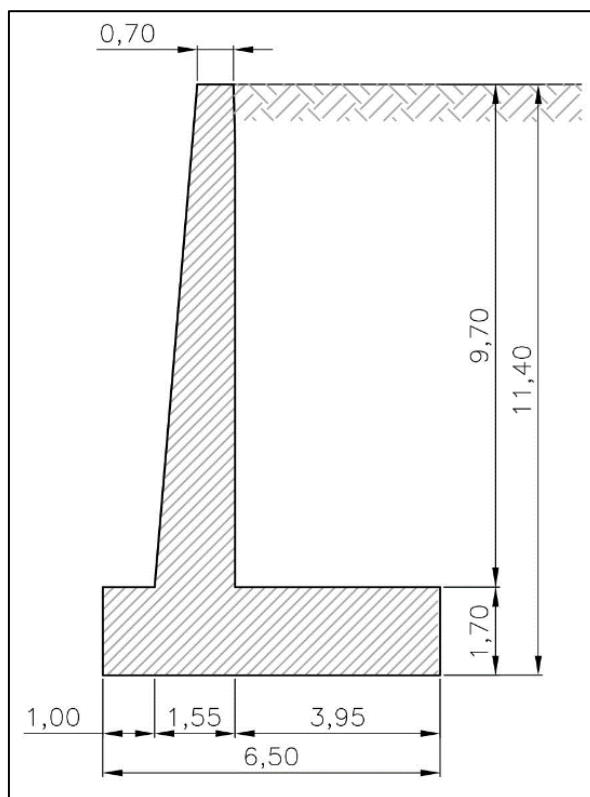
Geometria di calcolo dei muri del canale di restituzione
